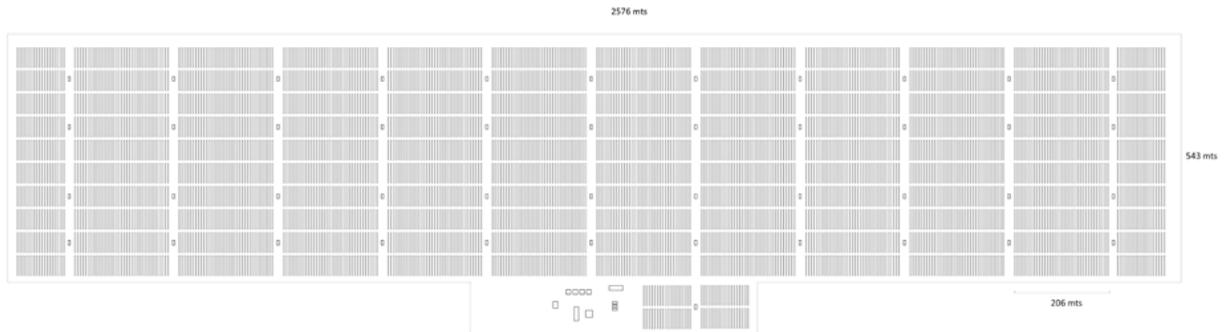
Planta del parque solar fotovoltaico "Salvador PV"
